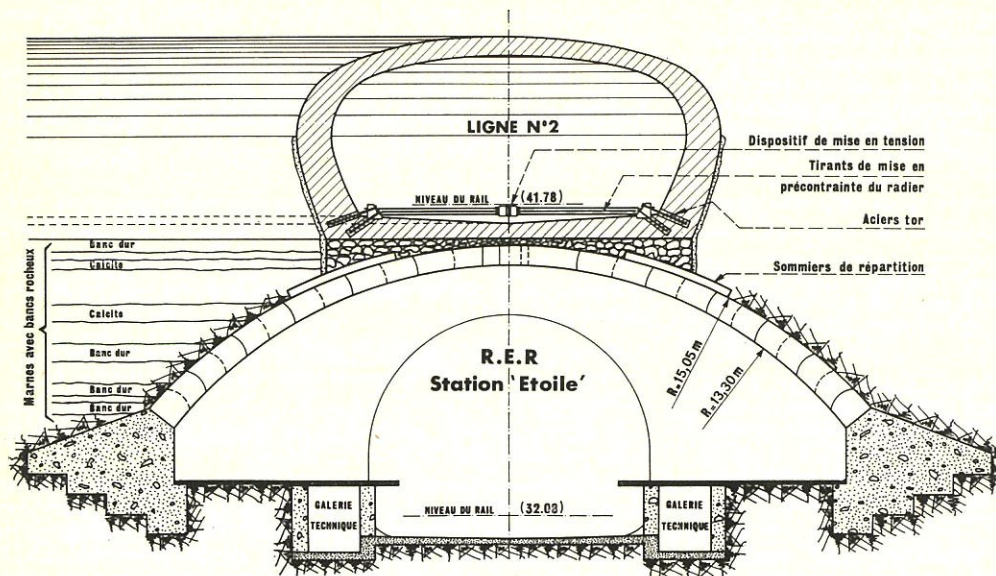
Partie Est de la station (175 m). Passage de la station sous le tunnel de la ligne n° 2. Coupe transversale.
